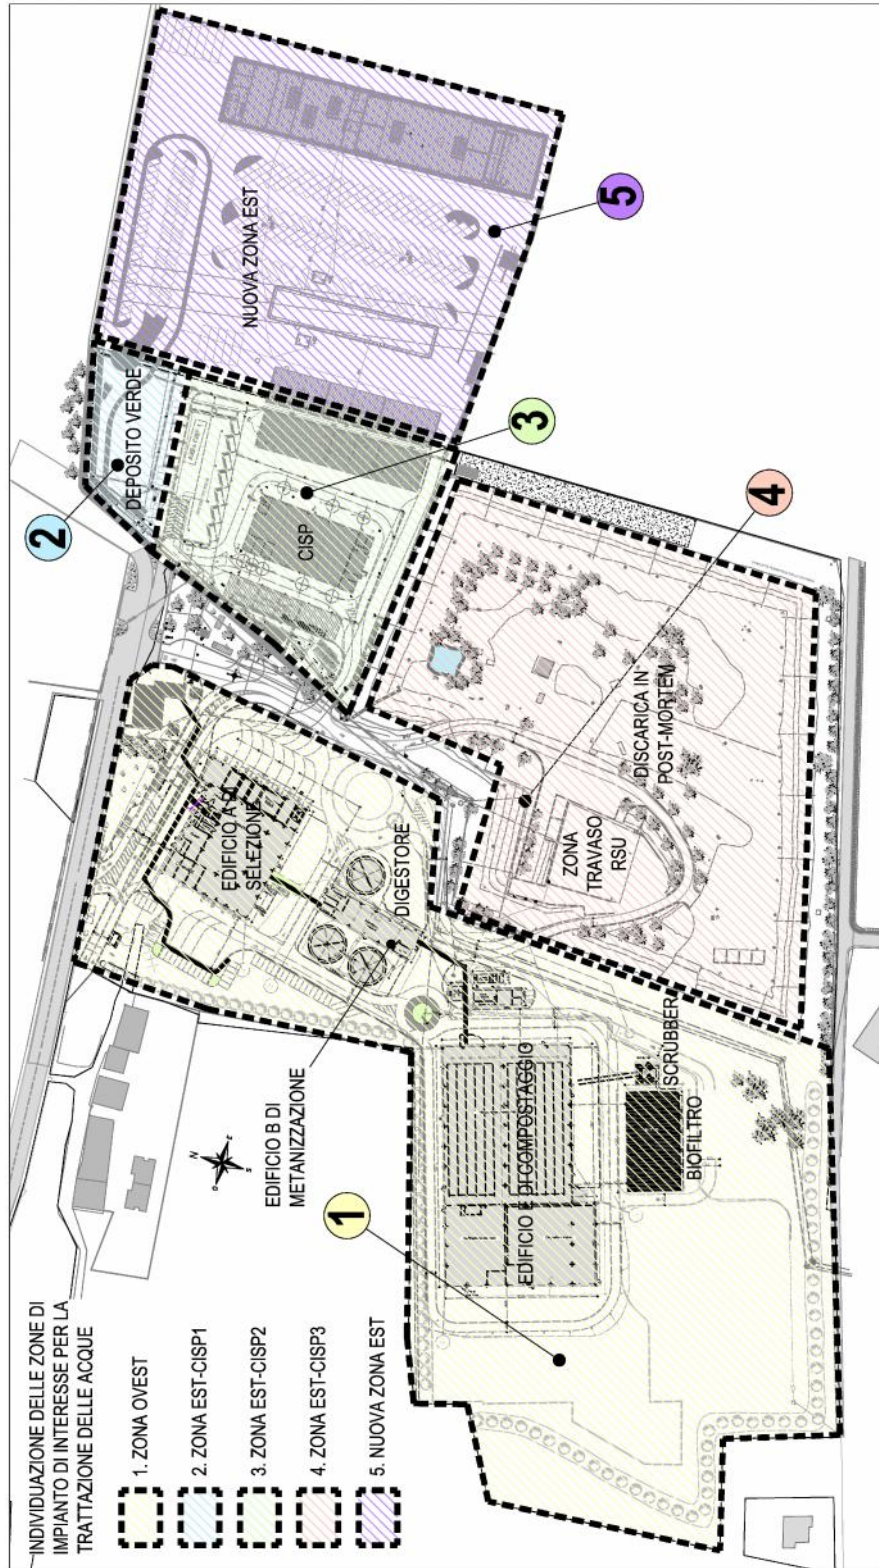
Suddivisione dell'area d'impianto nelle zone di specifico interesse (ad oggi).
